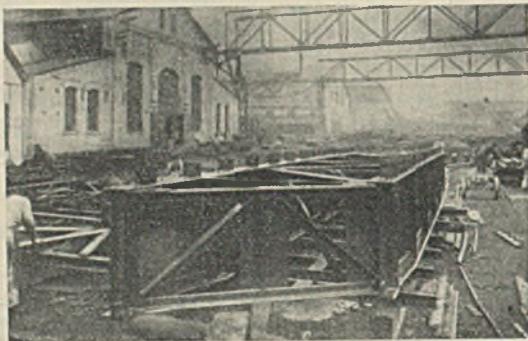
Vollständig geschweißte Blechträgerbrücke in Weiz, Steiermark.
